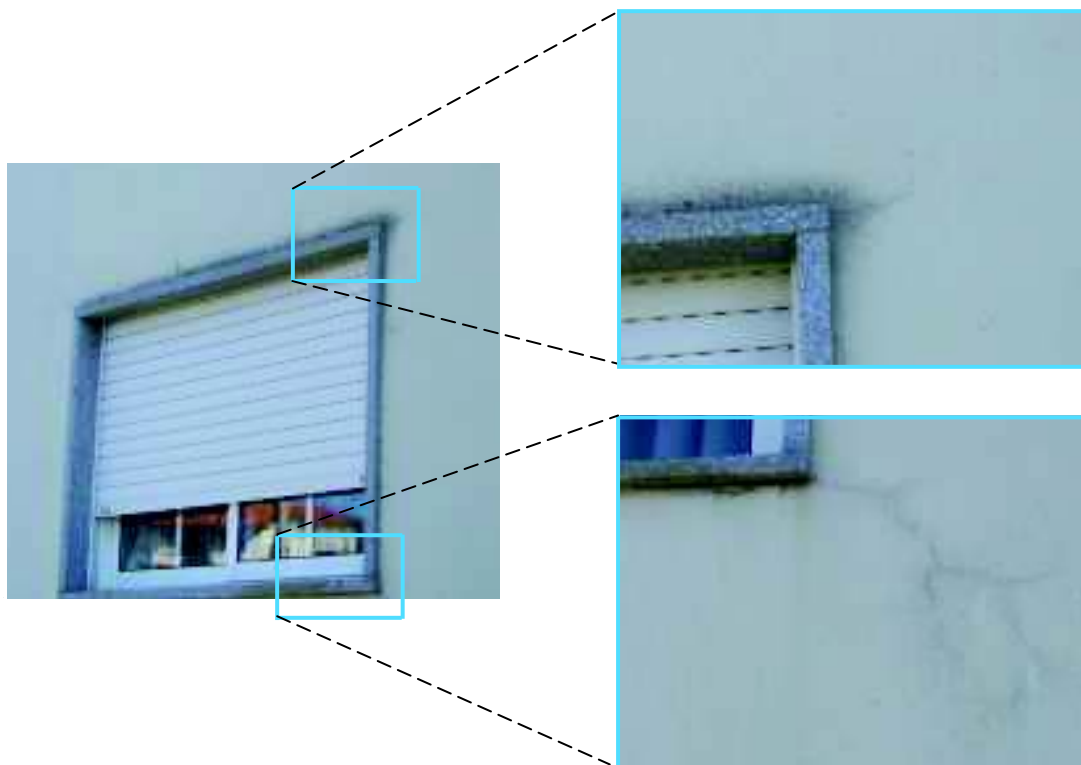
Fissuração e sujidade nos cantos dos vãos
